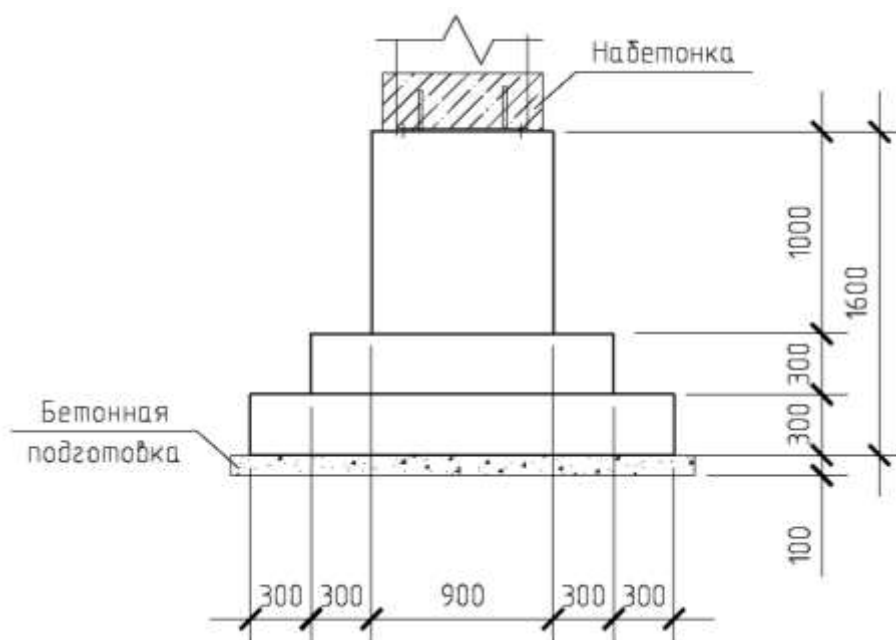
Монолитный фундамент (разрез 1-1)
